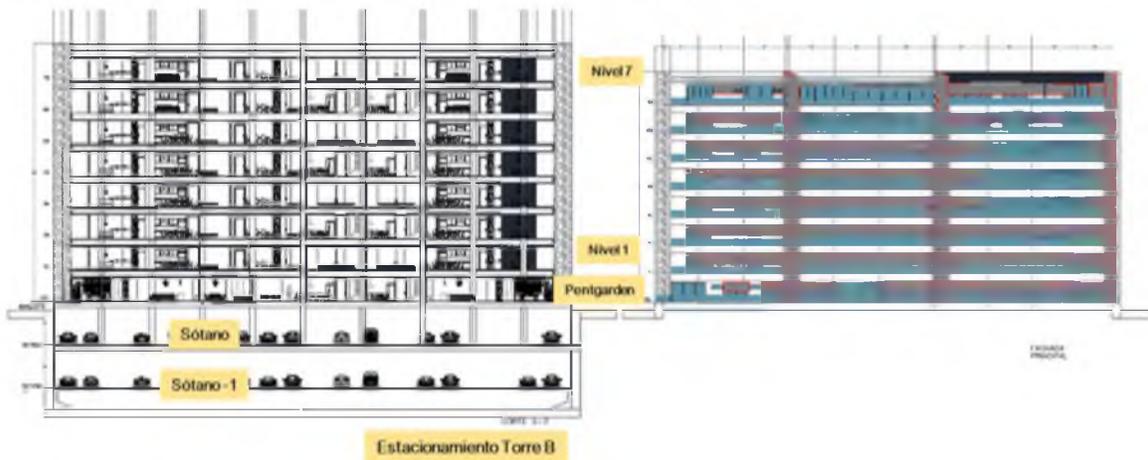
Fachada principal de Torre B y corte 2 -2 2.
